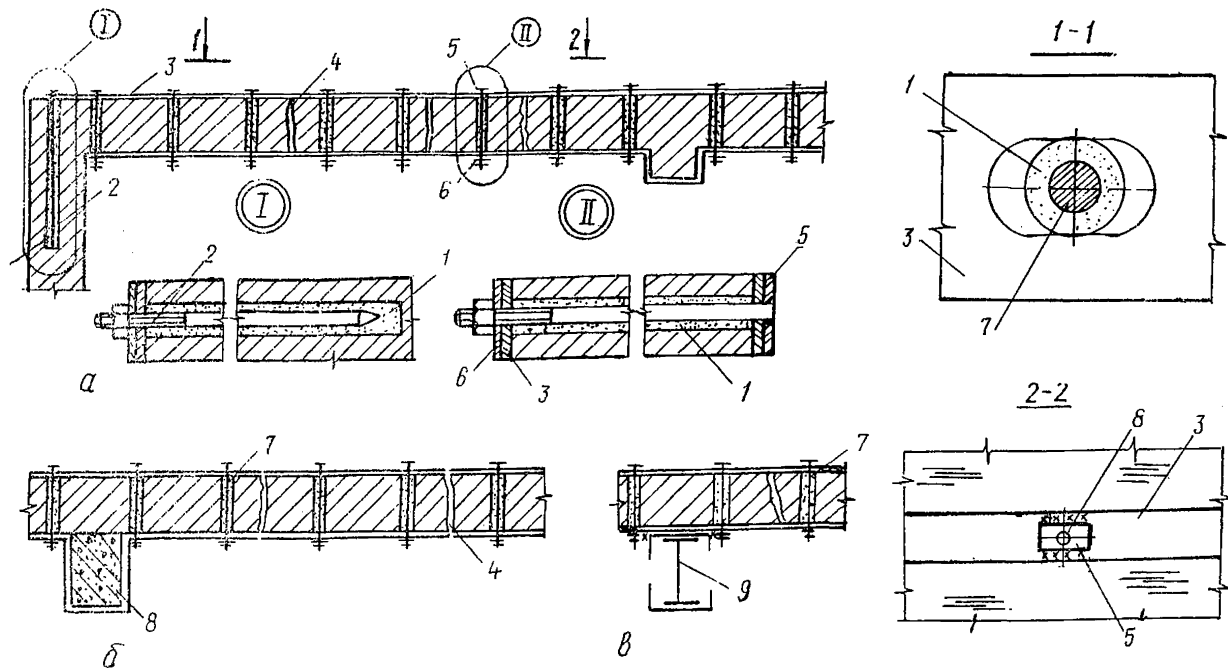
Схемы усиления каменной кладки, разбитой трещинами:
